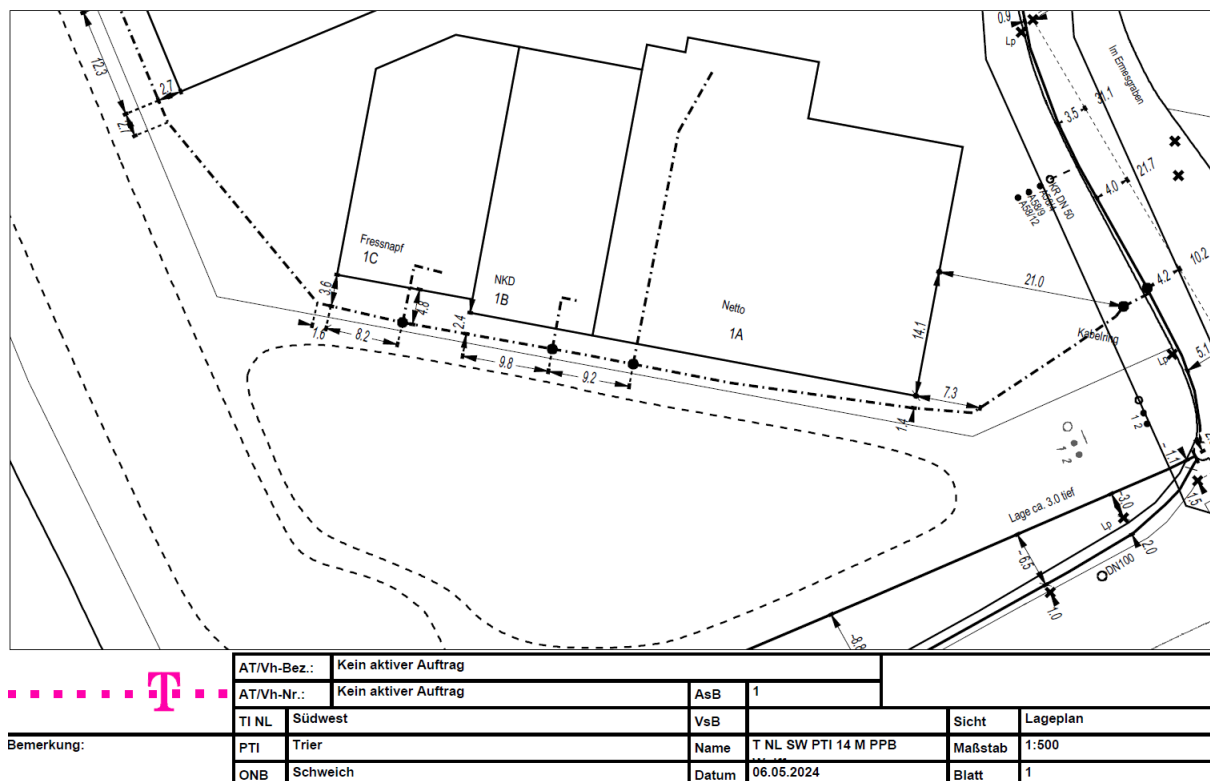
Lageplan bestehende Telekommunikationslinien
